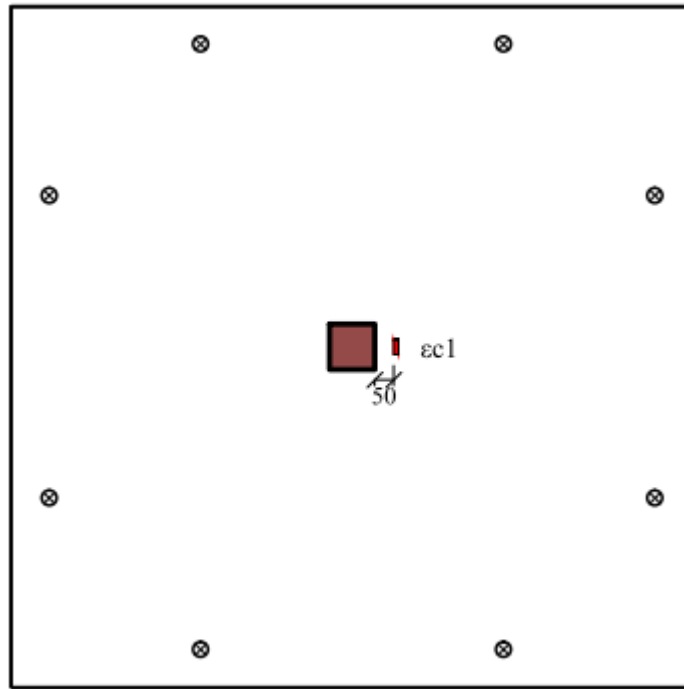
Disposição do extensômetro na superfície inferior das lajes.
